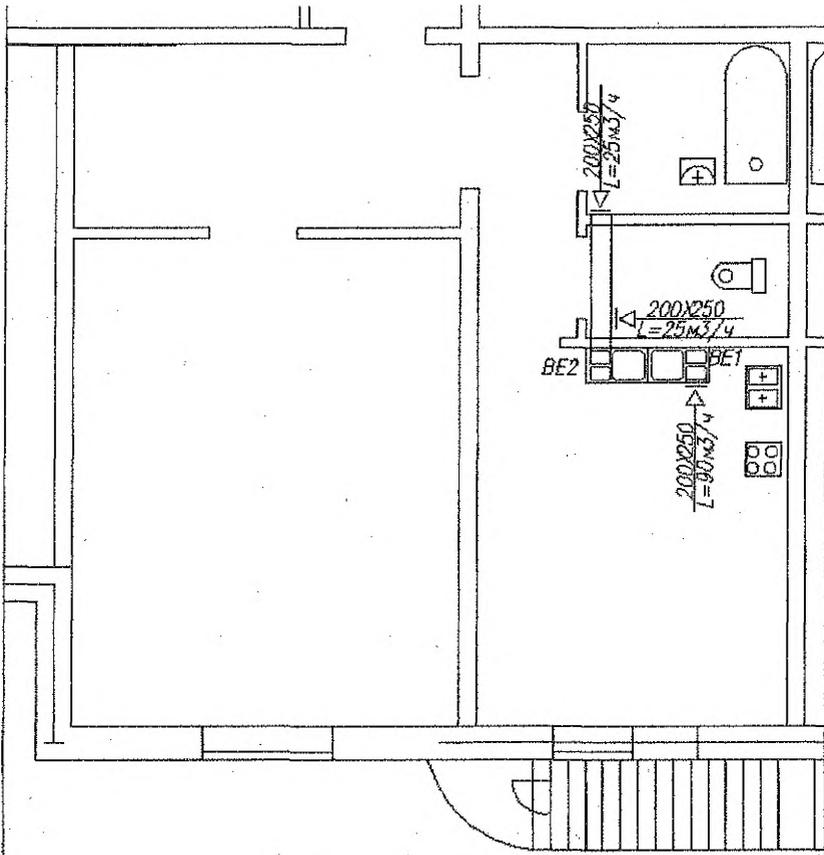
Фрагмент плана здания с нанесением элементов системы вентиляции
